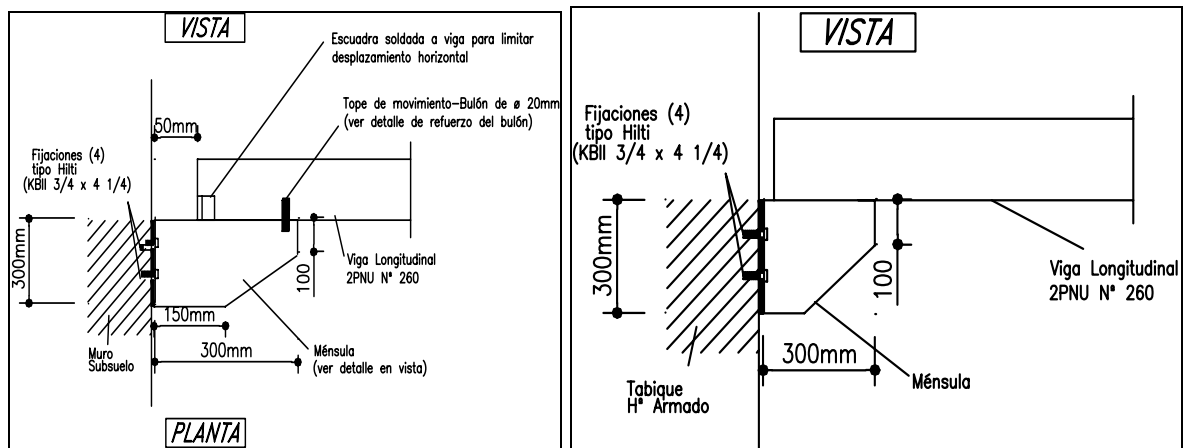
Detalles de la conexión de las escaleras metálicas a los edificios y en particular para la torre con aislamiento sísmico. (Ver también capítulo 9)
